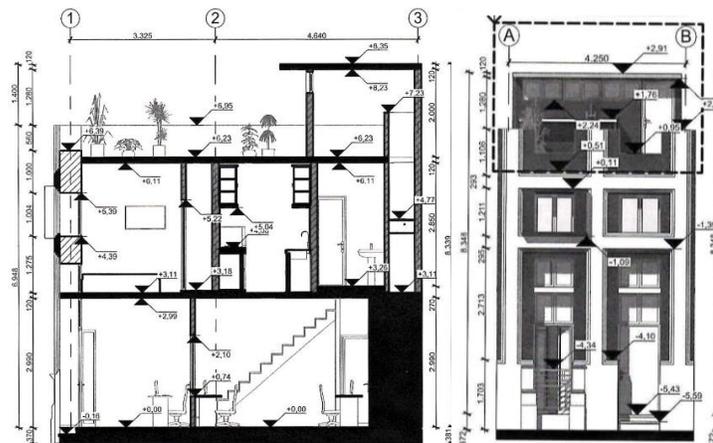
Façade et coupe de la maison (source : Diaz, 2019)
